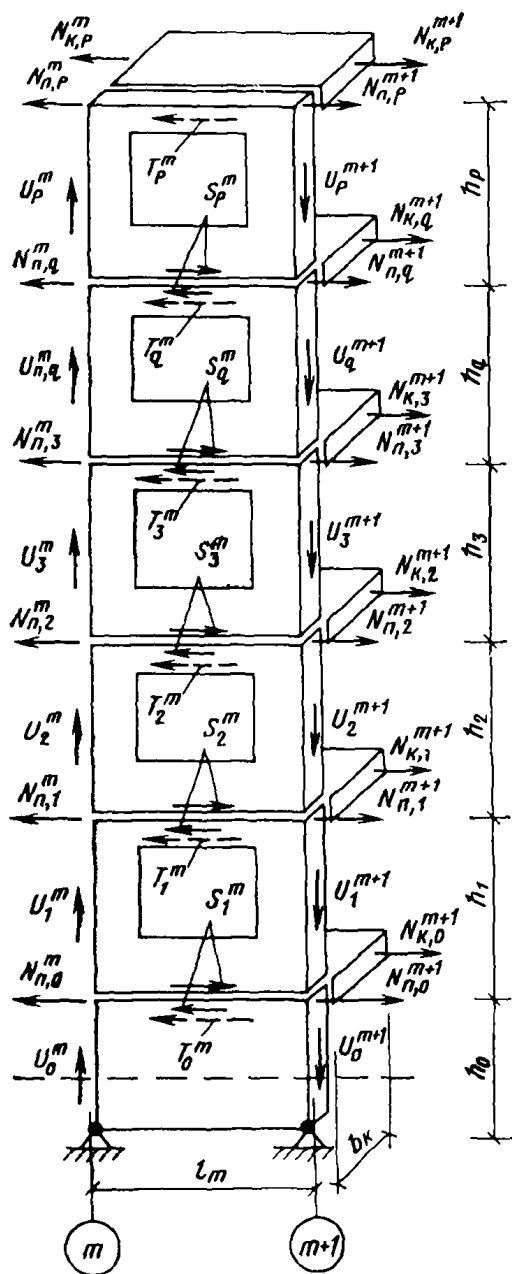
Температурные усилия в стеновых панелях и плитах перекрытий m -го столбца панелей
